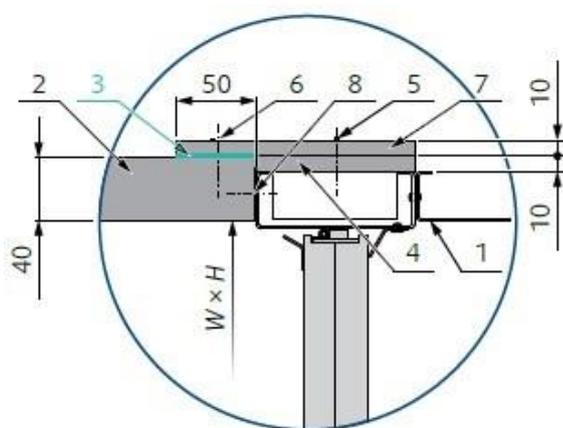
Sezione trasversale del collegamento con lastra della condotta di spessore 40 mm
